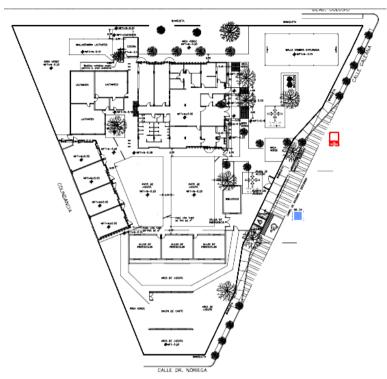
Planta Arquitectónica del Centro de Desarrollo Infantil. Fuente: Archivo de obras de UNISON.
